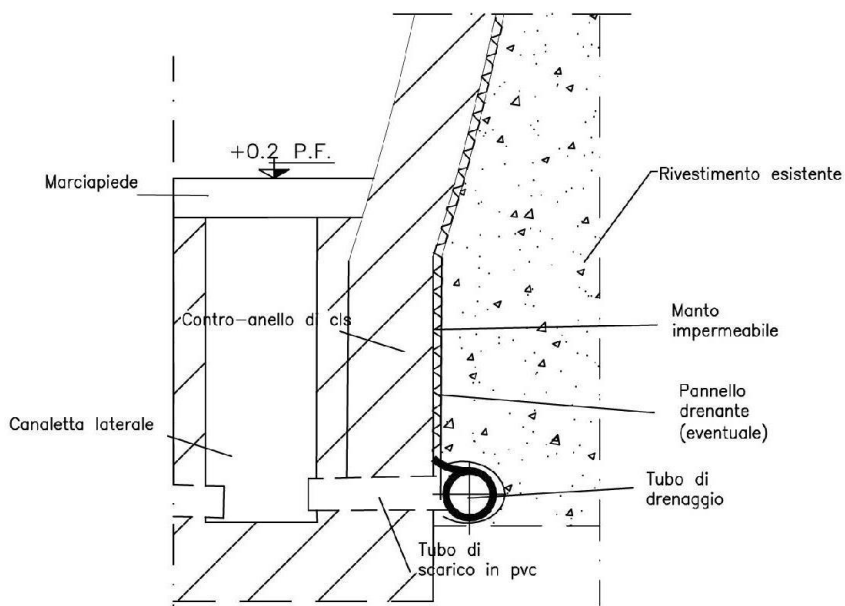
Intervento tipo in galleria – Particolare sistema drenante e marciapiede
